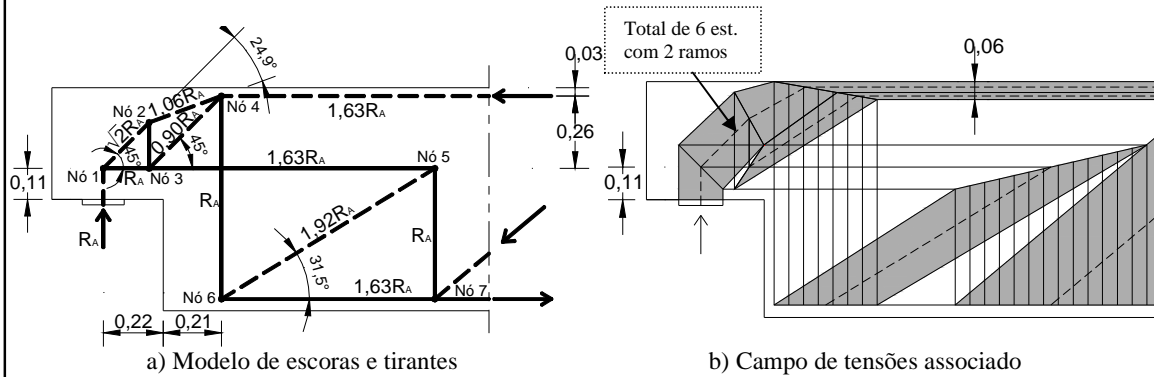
Modelo de escora e tirantes do apoio A adaptado à configuração fissurada.
